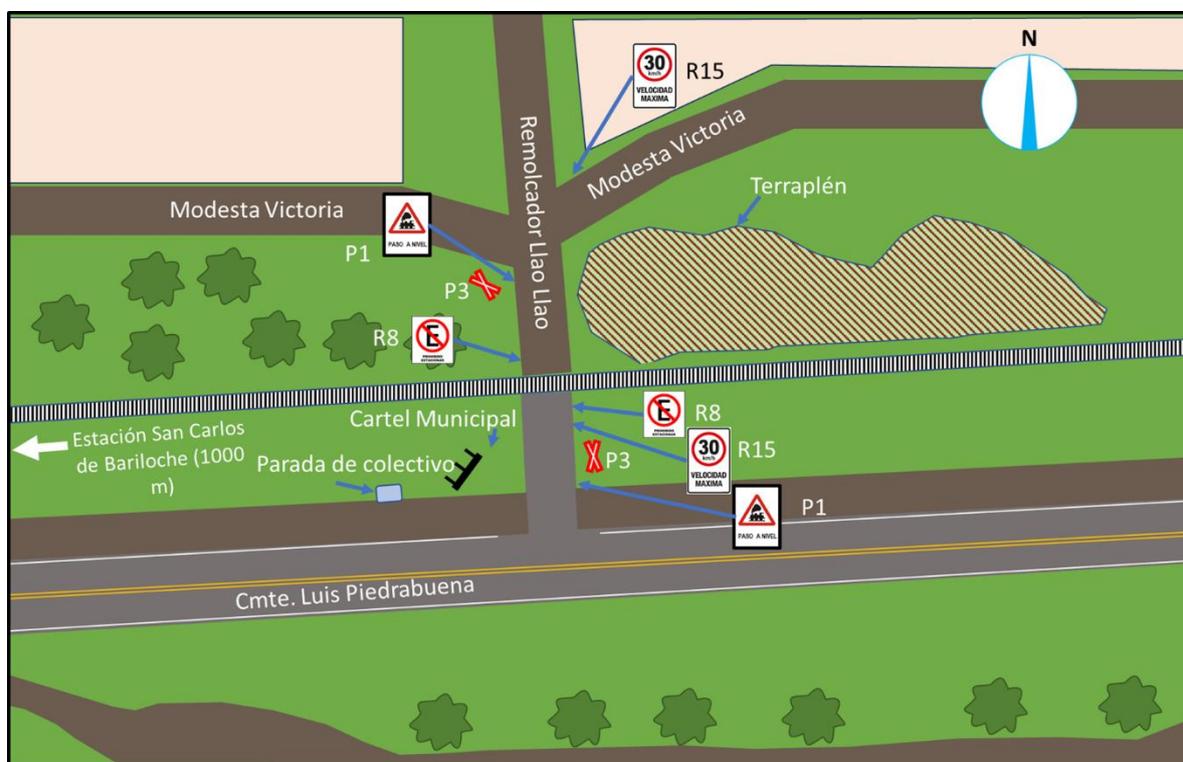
Estado del PAN encontrado durante el relevamiento de septiembre de 2023
